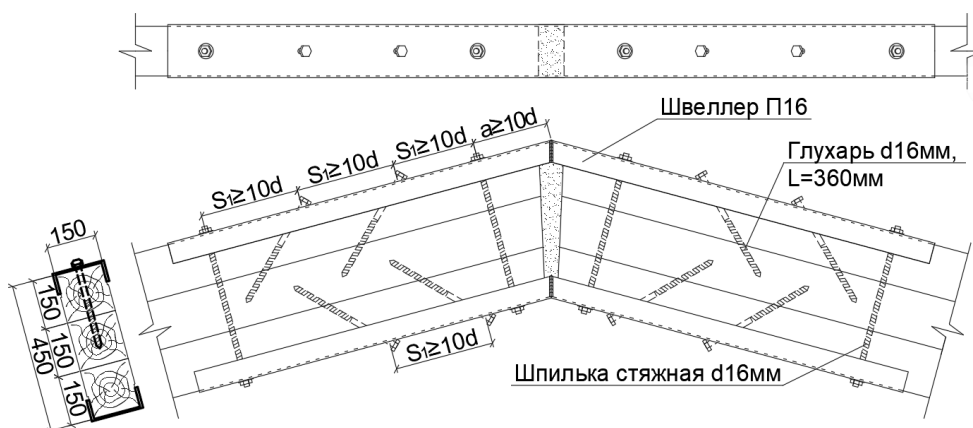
Схема узла сплачивания цельнодеревянных элементов.
